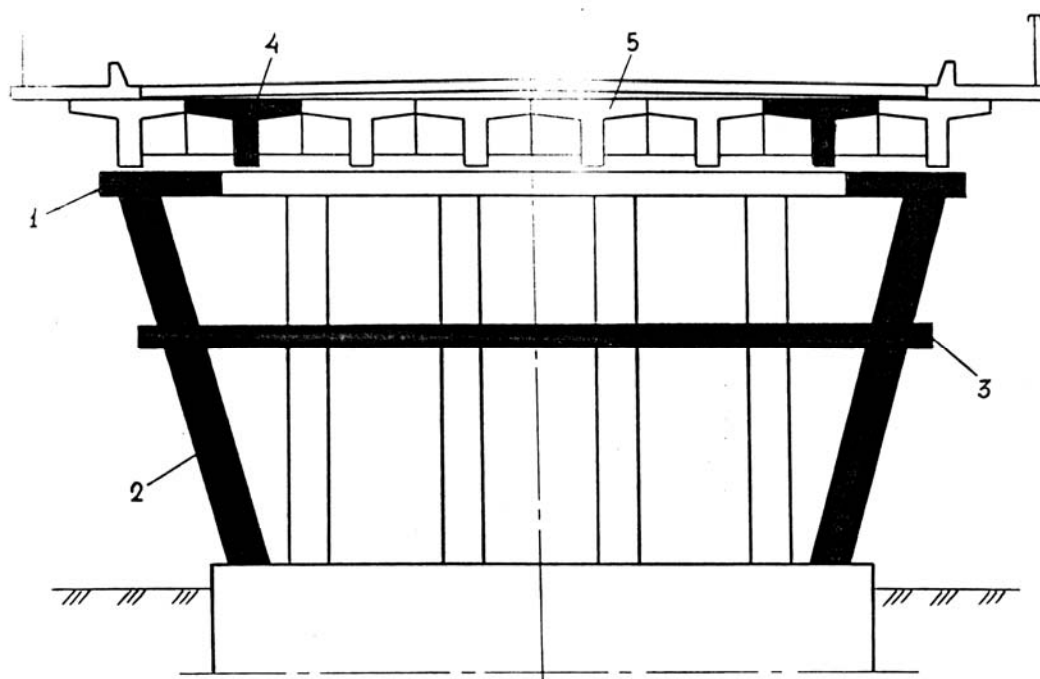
Схема установки балок с одно- и двухсторонними диафрагмами при уширении: 1 – удлинение ригеля; 2 – подкосы для опирания удлиненного ригеля; 3 – железобетонная схватка; 4 – дополнительные балки; 5 – существующие балки
